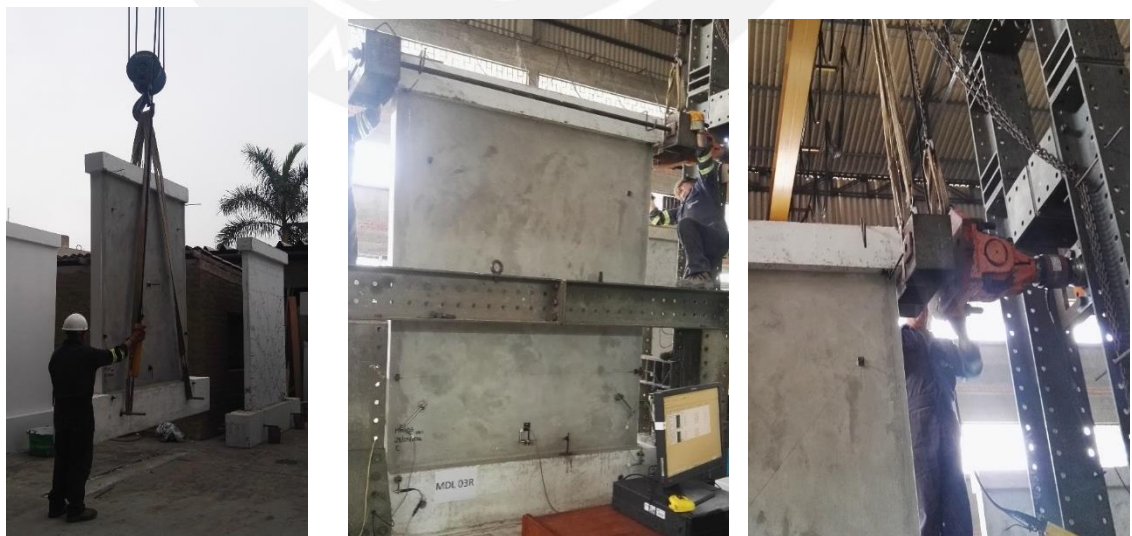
Izaje del muro, instrumentación externa al muro y colocación del actuador listo para el ensayo del MDL-R hasta la rotura.
